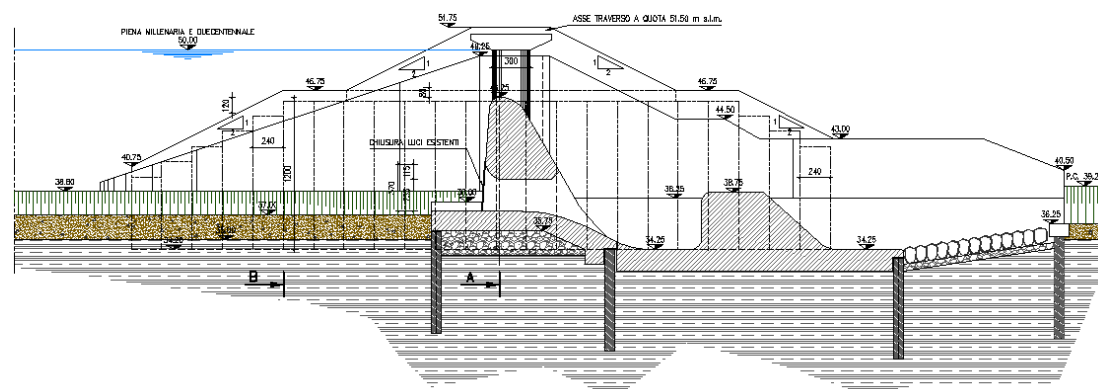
Adeguamento manufatto di regolazione in linea – Sezione tratti laterali
